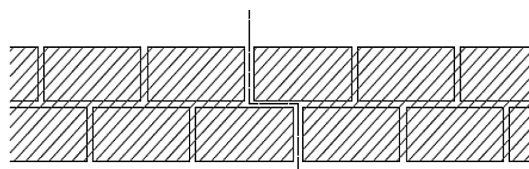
Junta de dilatación con solape. Esquema en planta.
